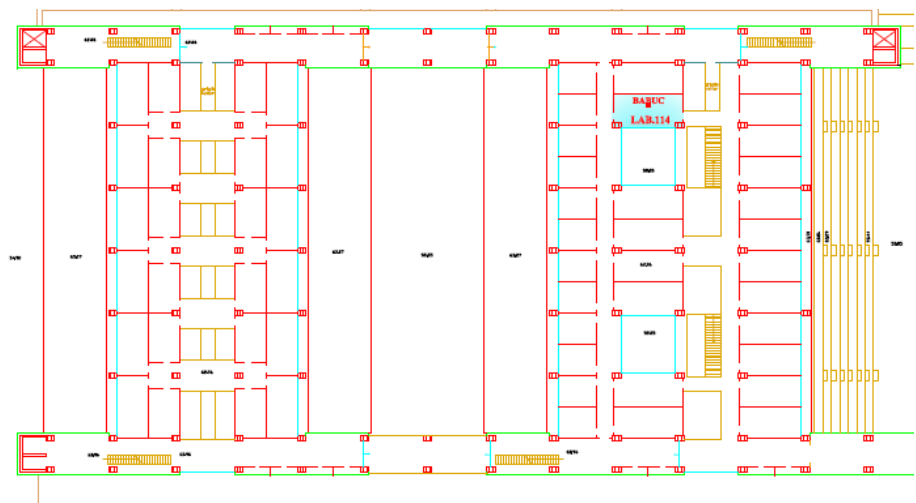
Edificio 17, collocazione in pianta del Laboratorio n. 114
